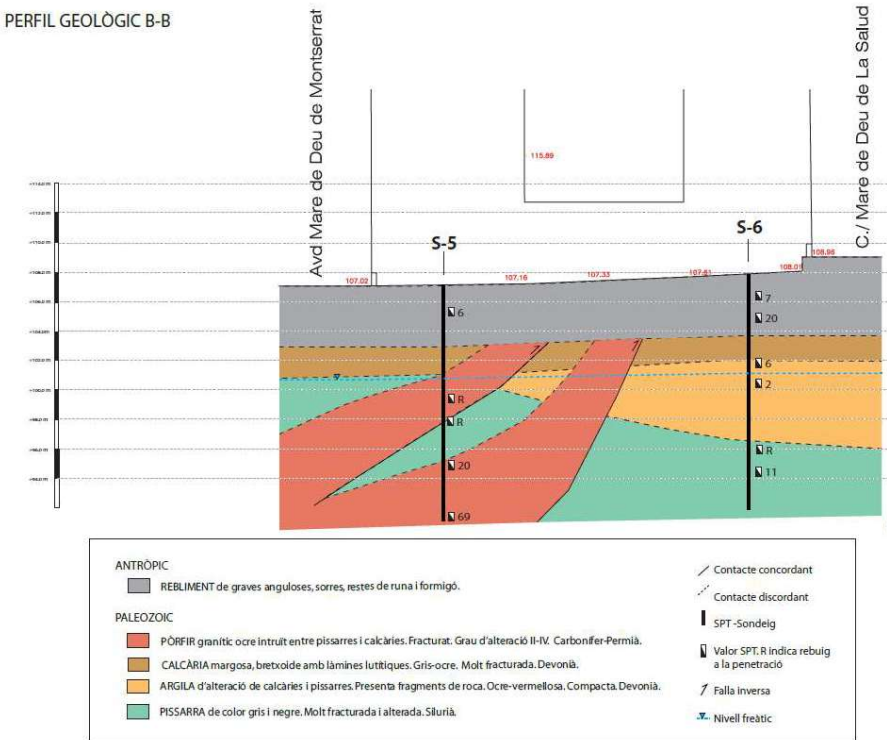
Perfil geotécnico B-B' (Fuente: Informe Geotécnico nº2123P6321)
